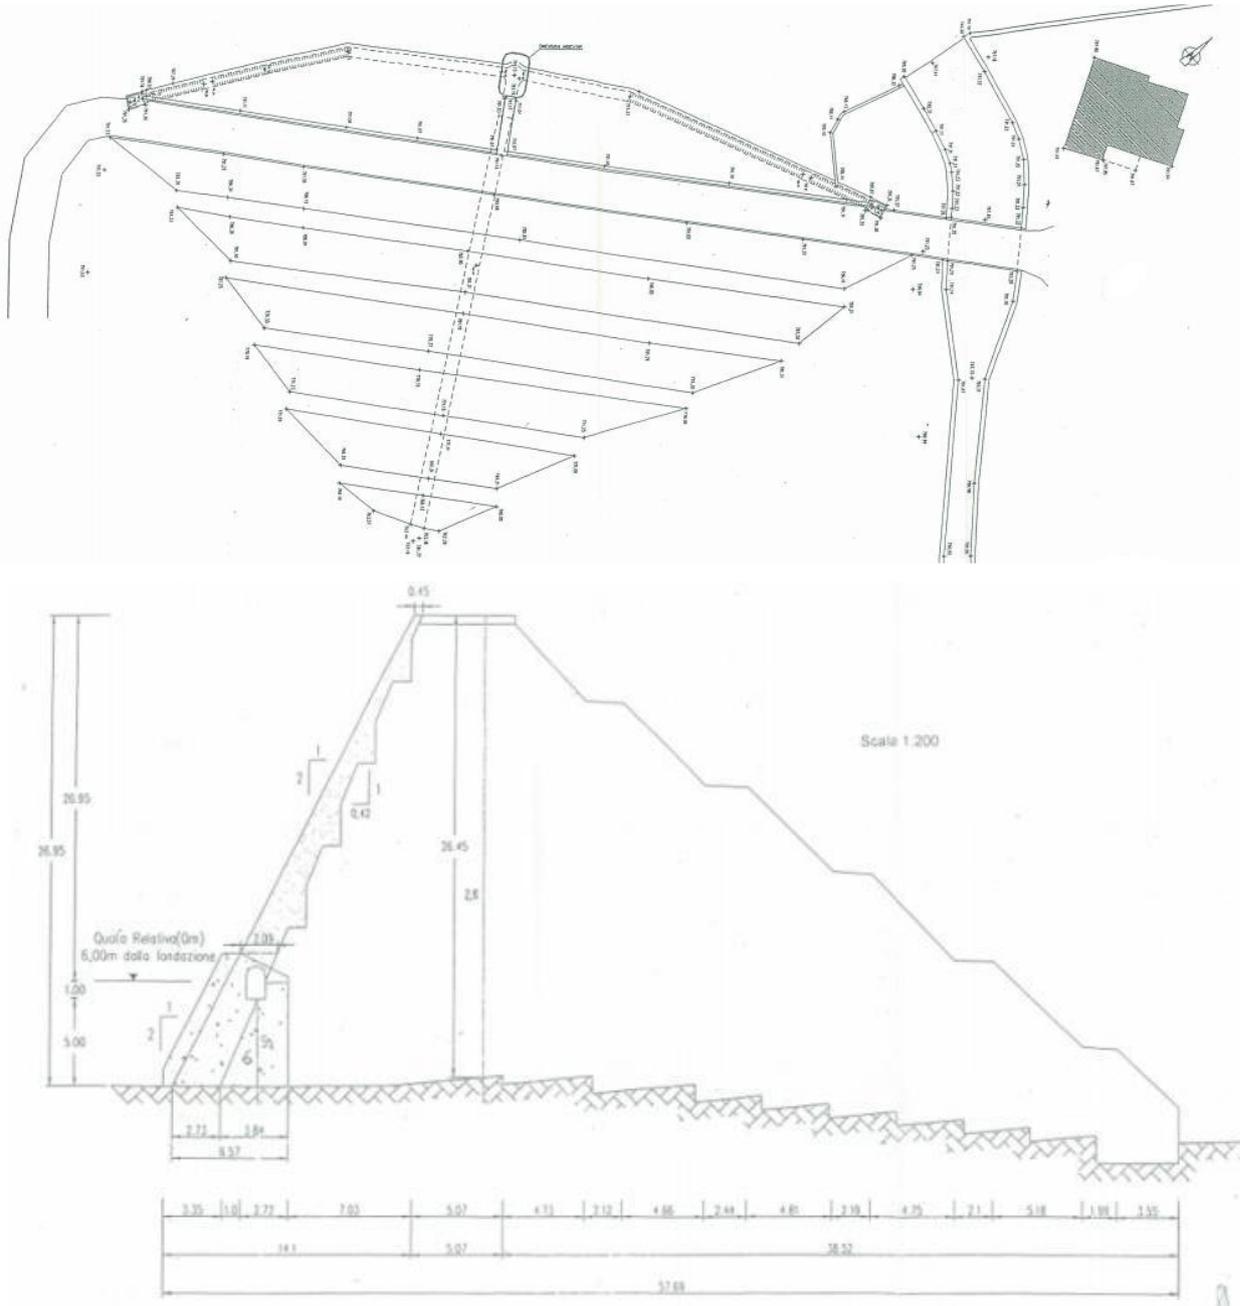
Pianta e sezione maestra della Diga di Cerventosa, tratte dal FCEM 2004
